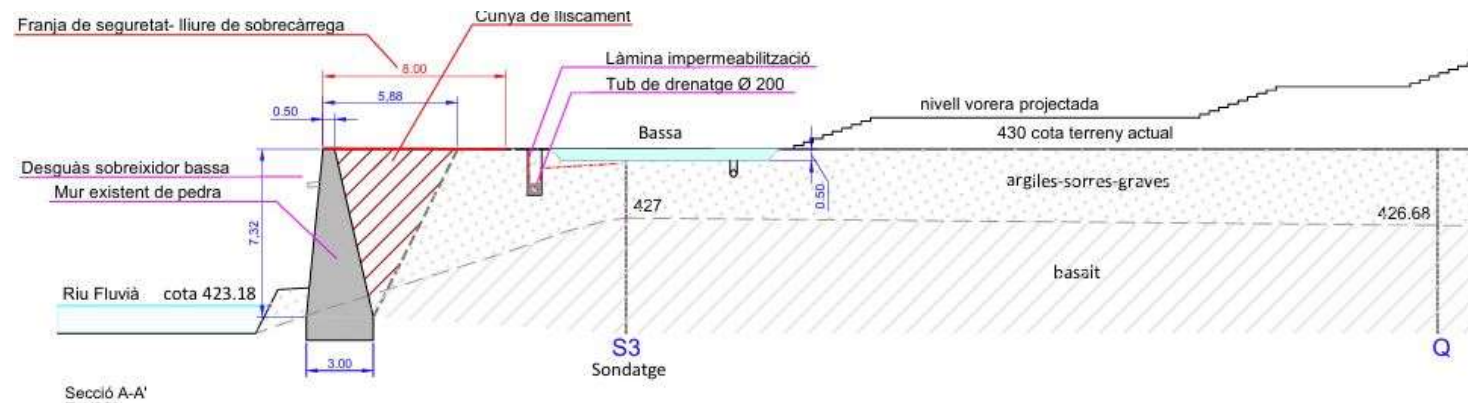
Impermeabilització i drenatge de la bassa naturalitzada
